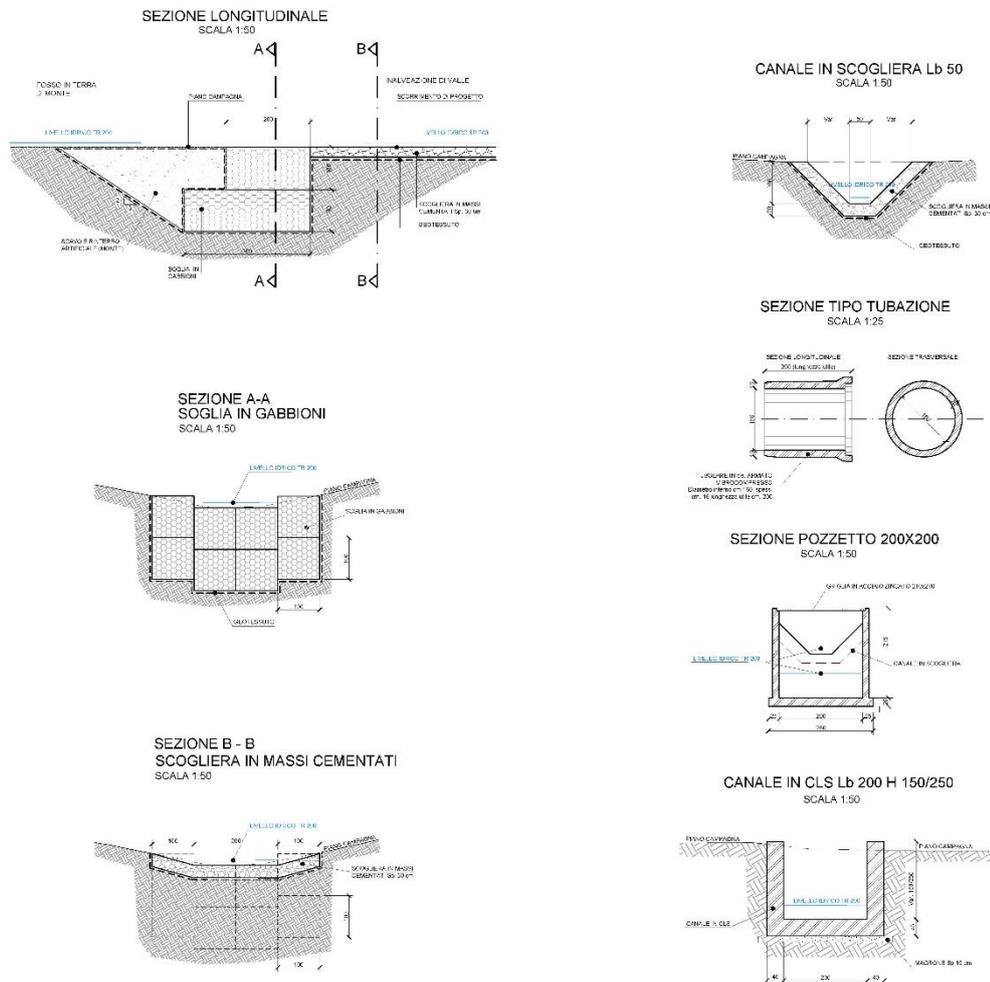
Fosso Fsn11 – Sezioni tipo inalveazione e soglia di fondo.
